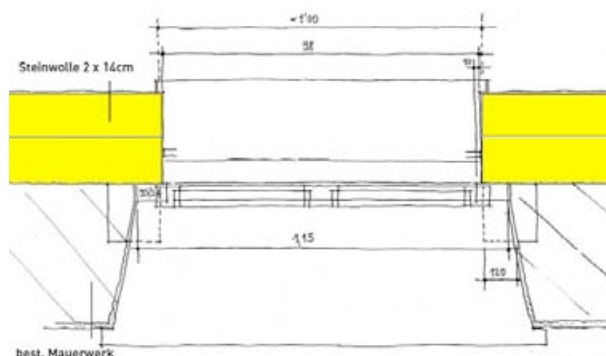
Grundriss AWD bei best. Mauerwerk
